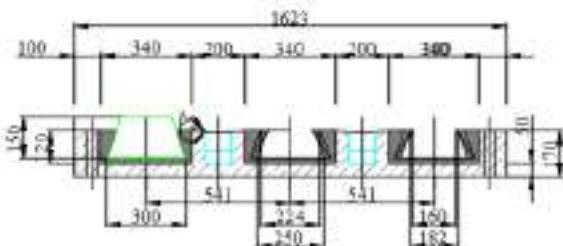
Новая железобетонная плита для безбалластного мостового полотна (вид сбоку)
